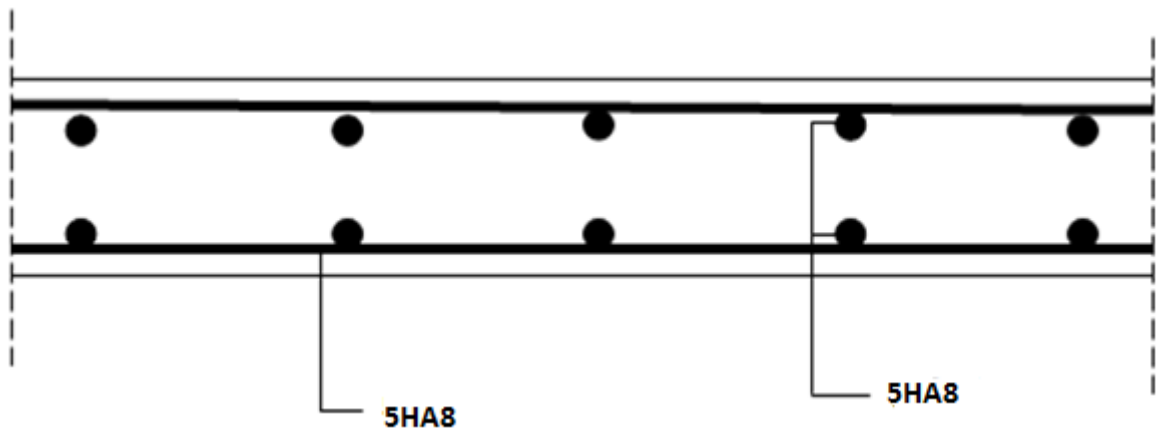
Plan de ferraillage de la salle machine suivant y-y.
